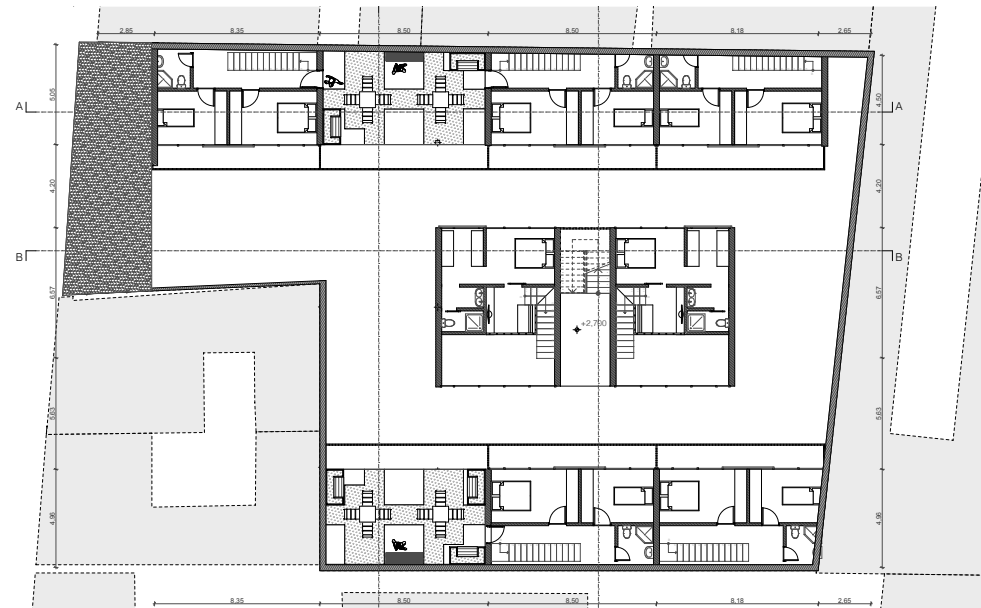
Primer planta alta Propuesta Conjunto Habitacional
